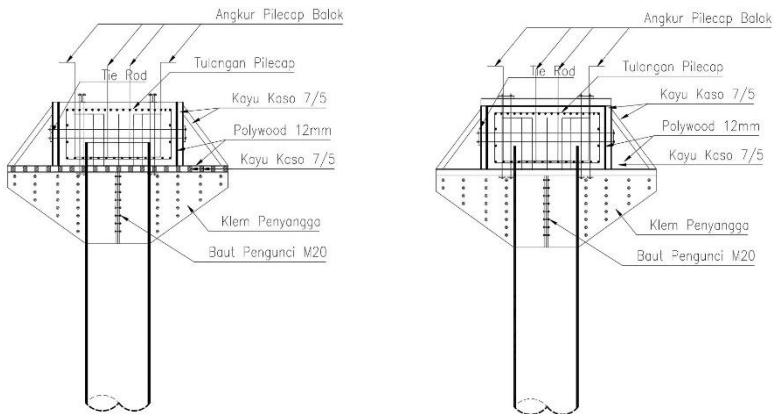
23 Pemasangan Perancah dan Beksiting Pile Cap
